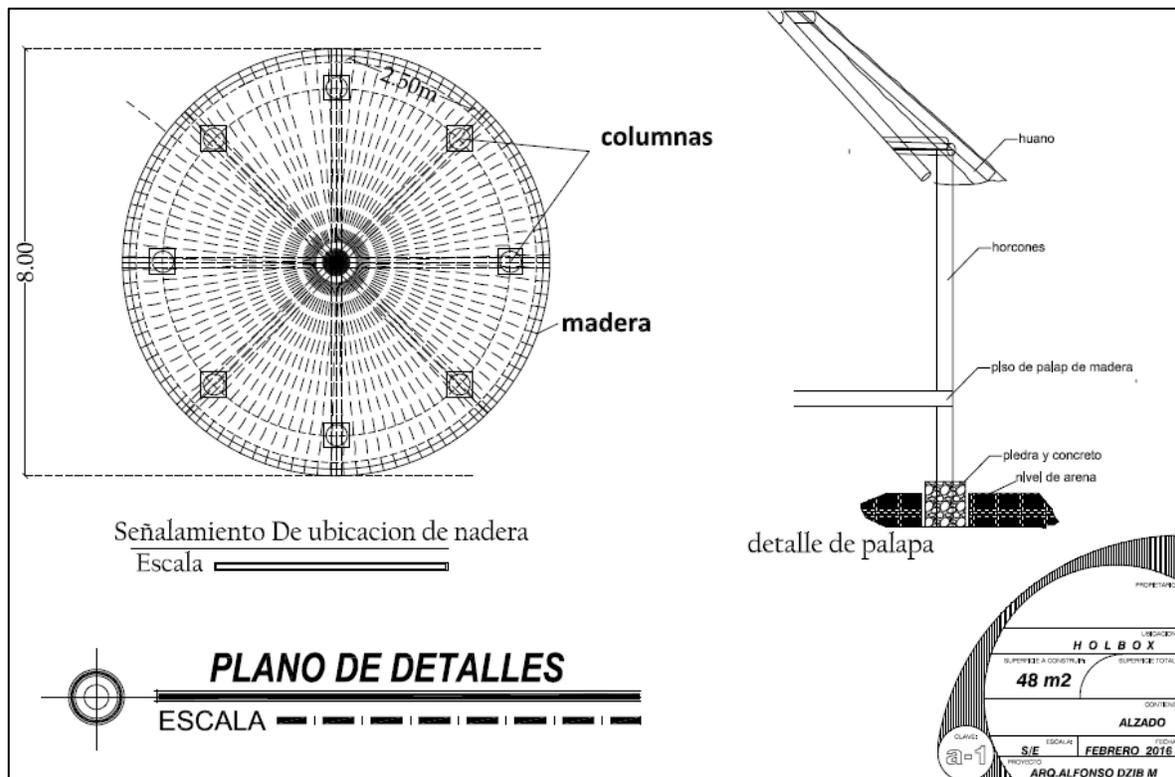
Detalle de la ubicación de las columnas y su cimentación.
